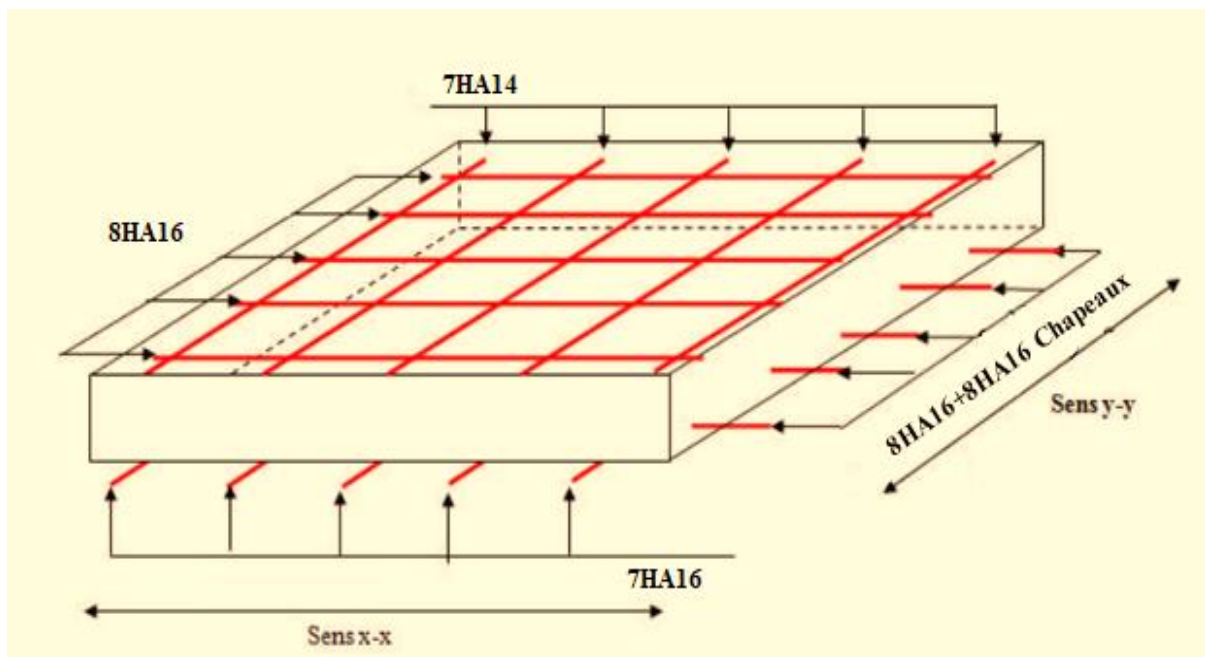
Schéma de ferrailage du radier présenter en 3D.
